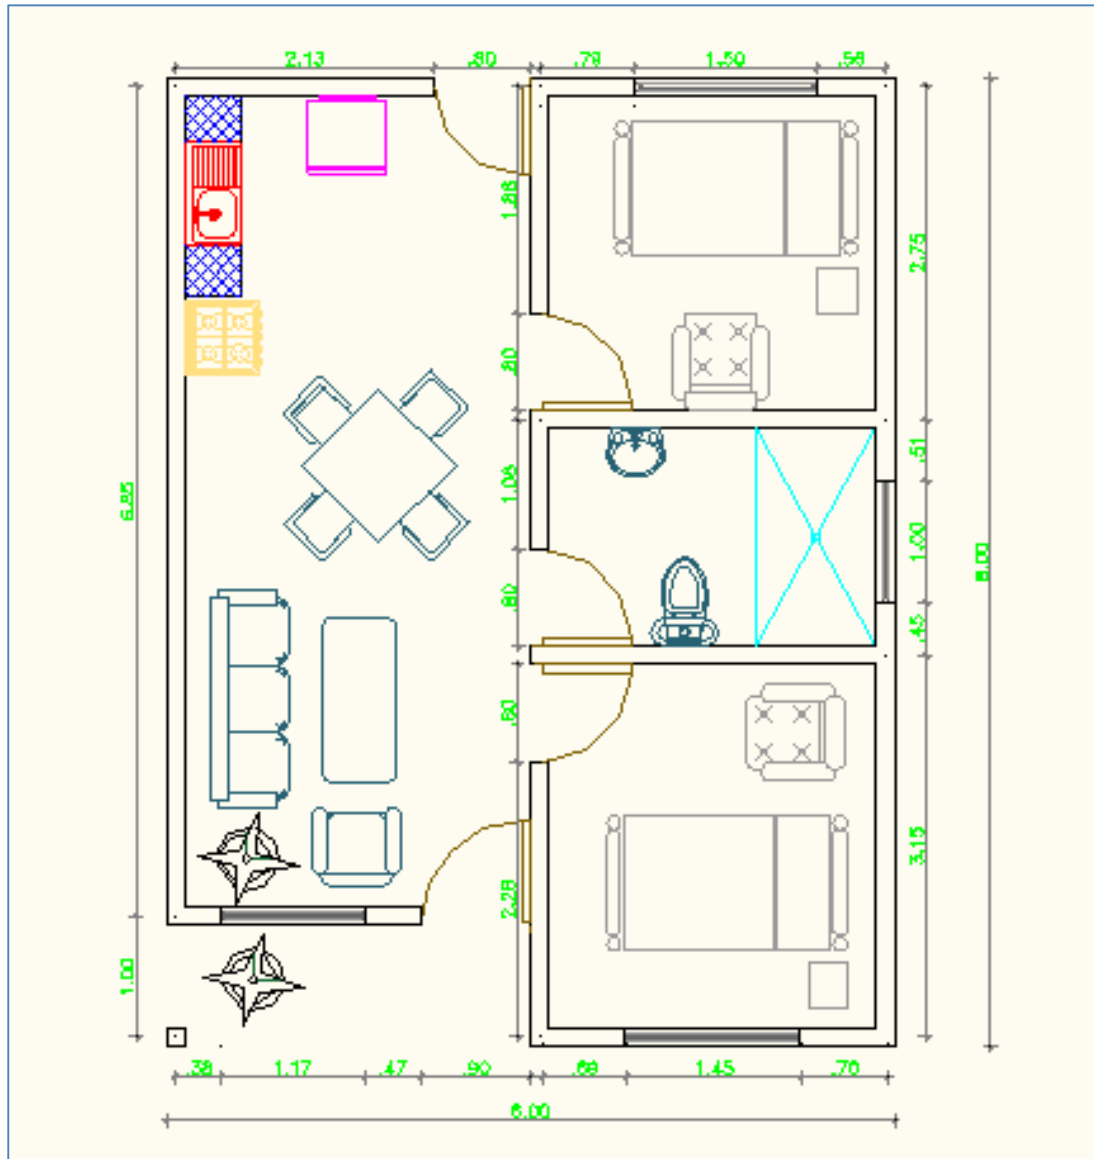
VISTA EN PLANTA VIVIENDA EN MADERA
